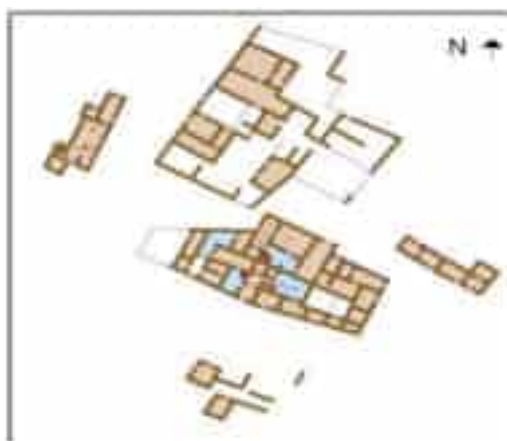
Plan du village médiéval (Source : mémoire NAILI 2020)
